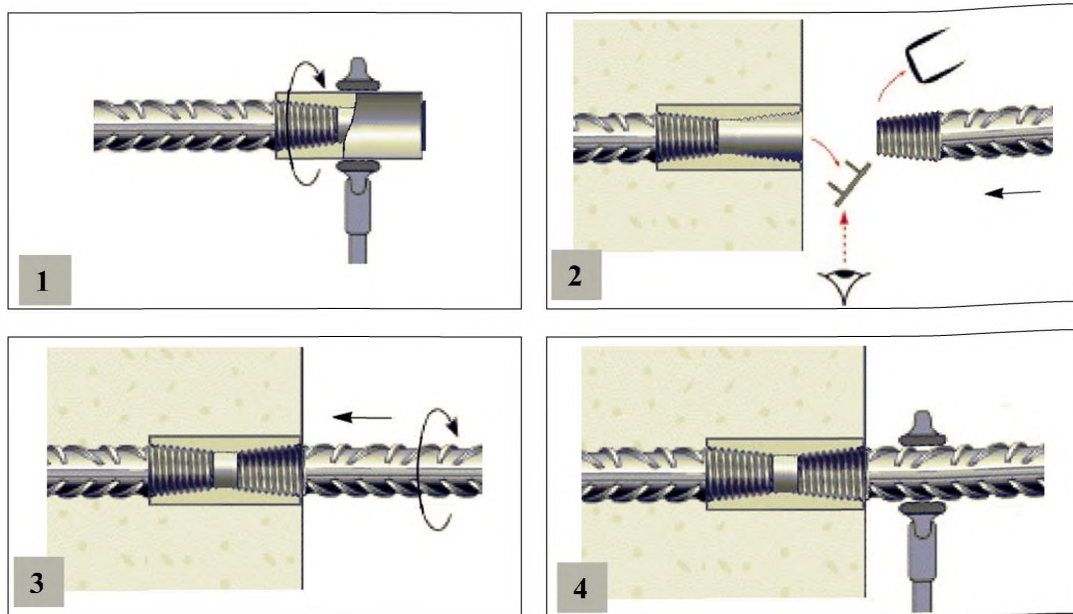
Сборка стандартных соединений с конической резьбой
